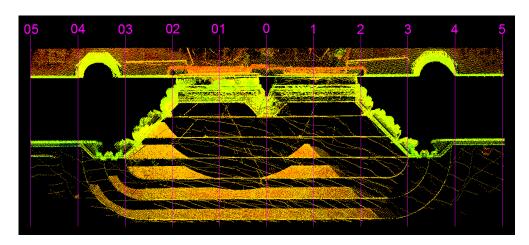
PUERTA PRINCIPAL. Vista en planta de la nube de puntos en el levantamiento de la puerta. Destaca la división creada para identificar las secciones verticales. Fuente propia.
